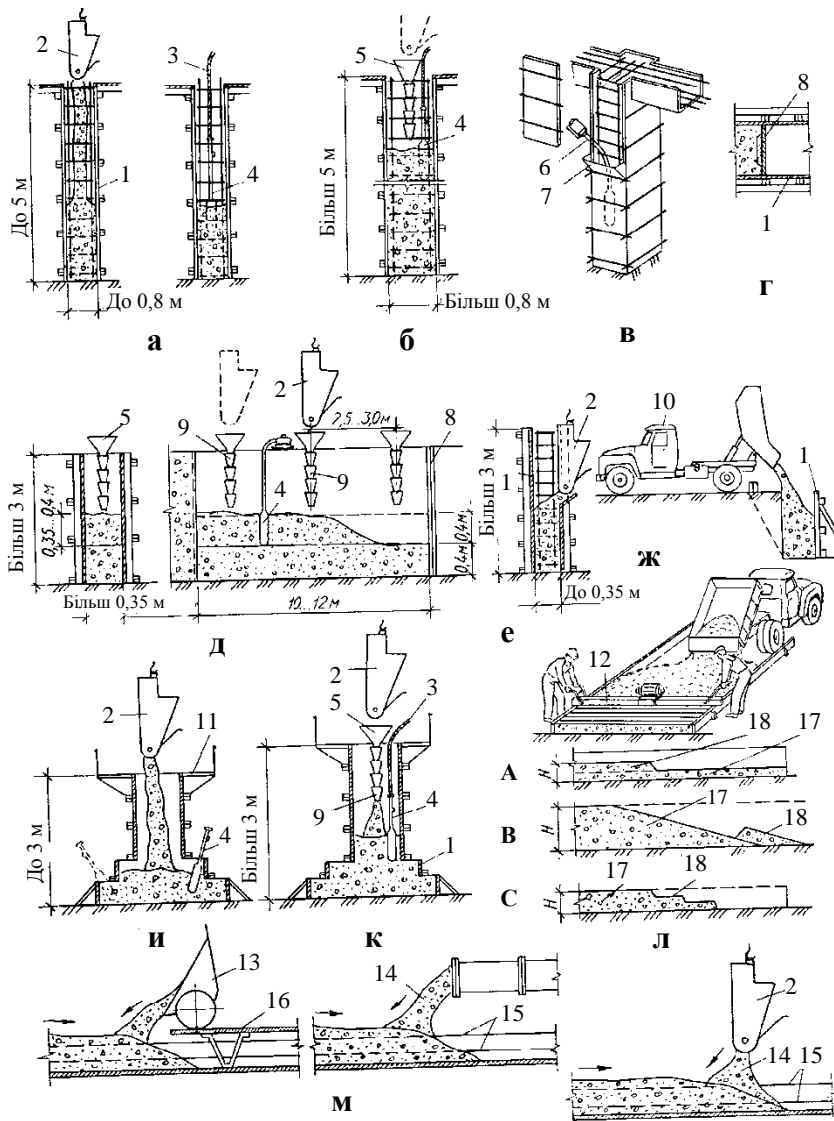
Схеми бетонування: а – колони до 5 м заввишки; б – колони більше 5 м заввишки; в – колони в разі густої арматури балок; г – установлення щита розподільної опалубки; д – товстої стіни; е – густоармованої тонкої стіни; ж – підпірної стіни; и – східчастого фундаменту до 3 м заввишки; к – те саме, більше 3 м заввишки; л – плити по грунту (А – горизонтальними шарами; В – похилими шарами; С – ступенями); м – плити для підготовки; 1 – опалубка; 2 – цебер; 3 – мотузка; 4 – глибинний вібратор; 5 – лійка хобота; 6 – вібратор з гнучким валом; 7 – кишень; 8 – розподільний щит; 9 – хобот; 10 – автобетоновоз; 11 – підмостки; 12 – вібробрус; 13 – тачка; 14 – бетонна суміш; 15 – арматура; 16 – качальний хід; 17 – покладений шар бетону; 18 – укладення шару бетонної суміші
